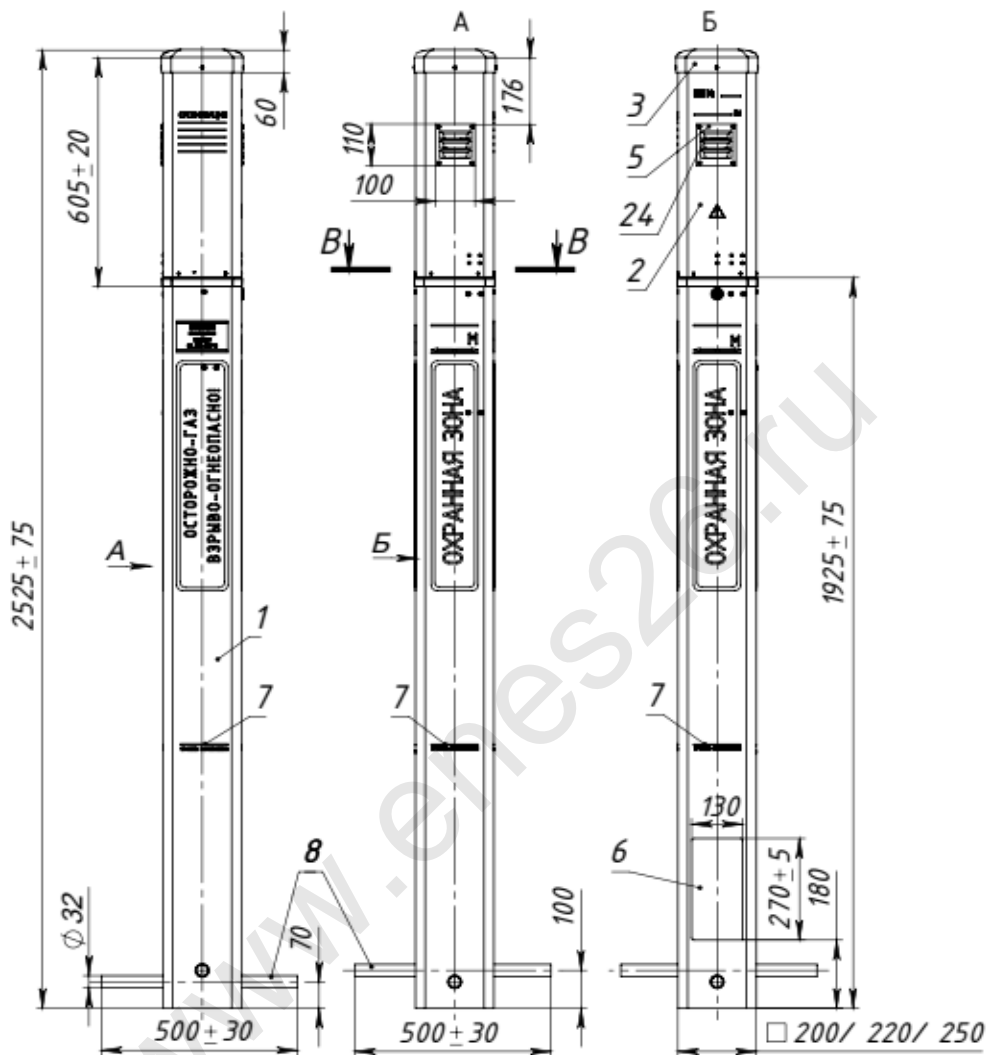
Корпус ЗГАНС® УКМ-КИП
